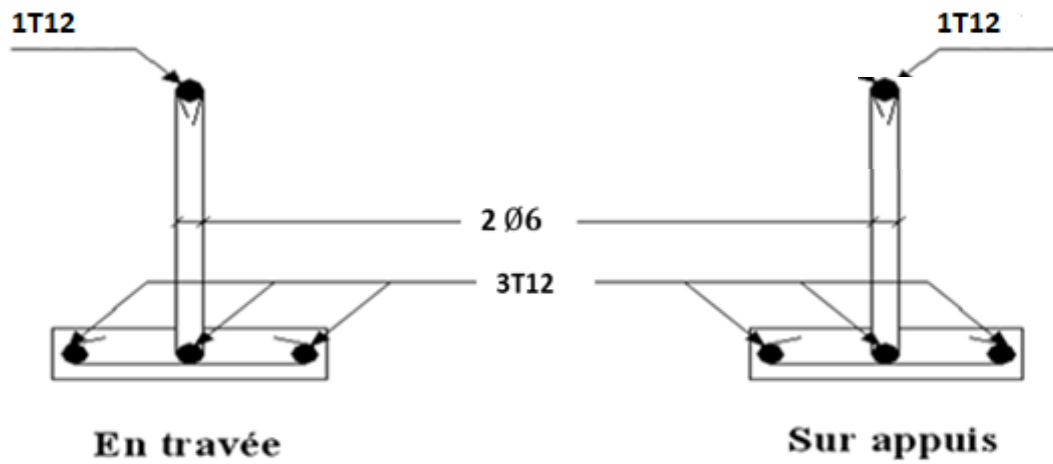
ferrailage des poutrelles en travée, et en appuis
